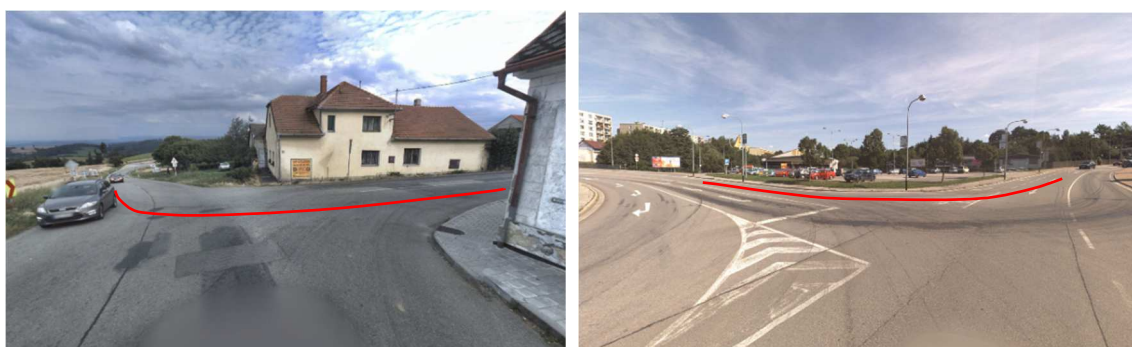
trasa dopravy prvků železobetonového skeletu na stavenišť a zpět
